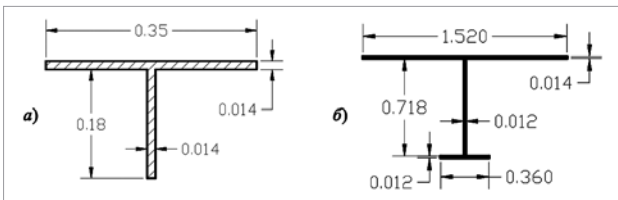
Расчетные сечения: а — продольное ребро; б — поперечная балка
